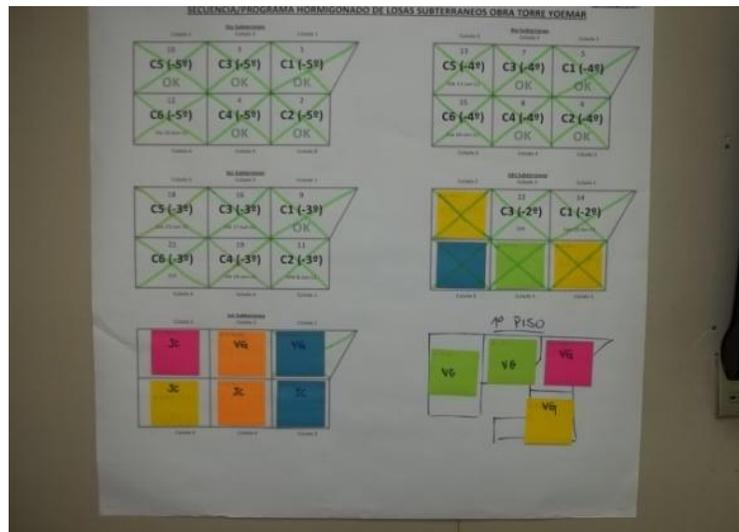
Planificación del proyecto en construcción representado por diagramas y coladas de hormigonado.
